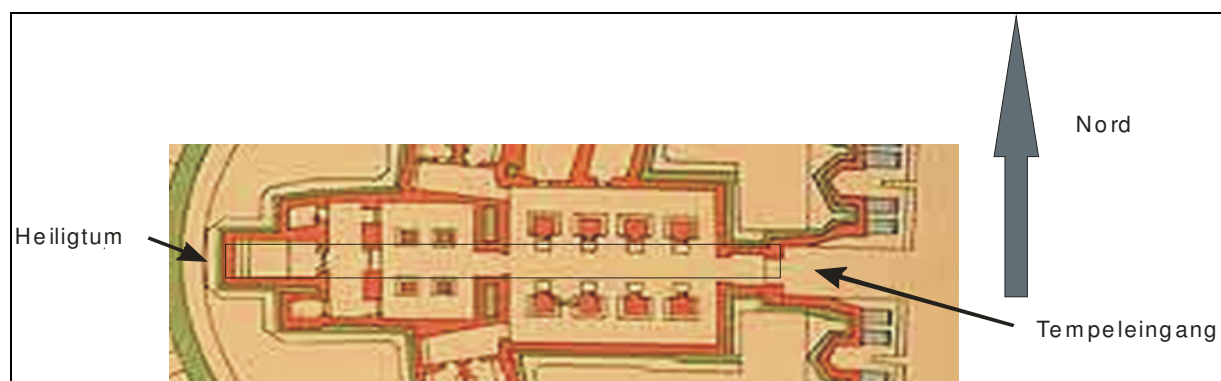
Grundriss des großen Tempels (Ausschnitt)
